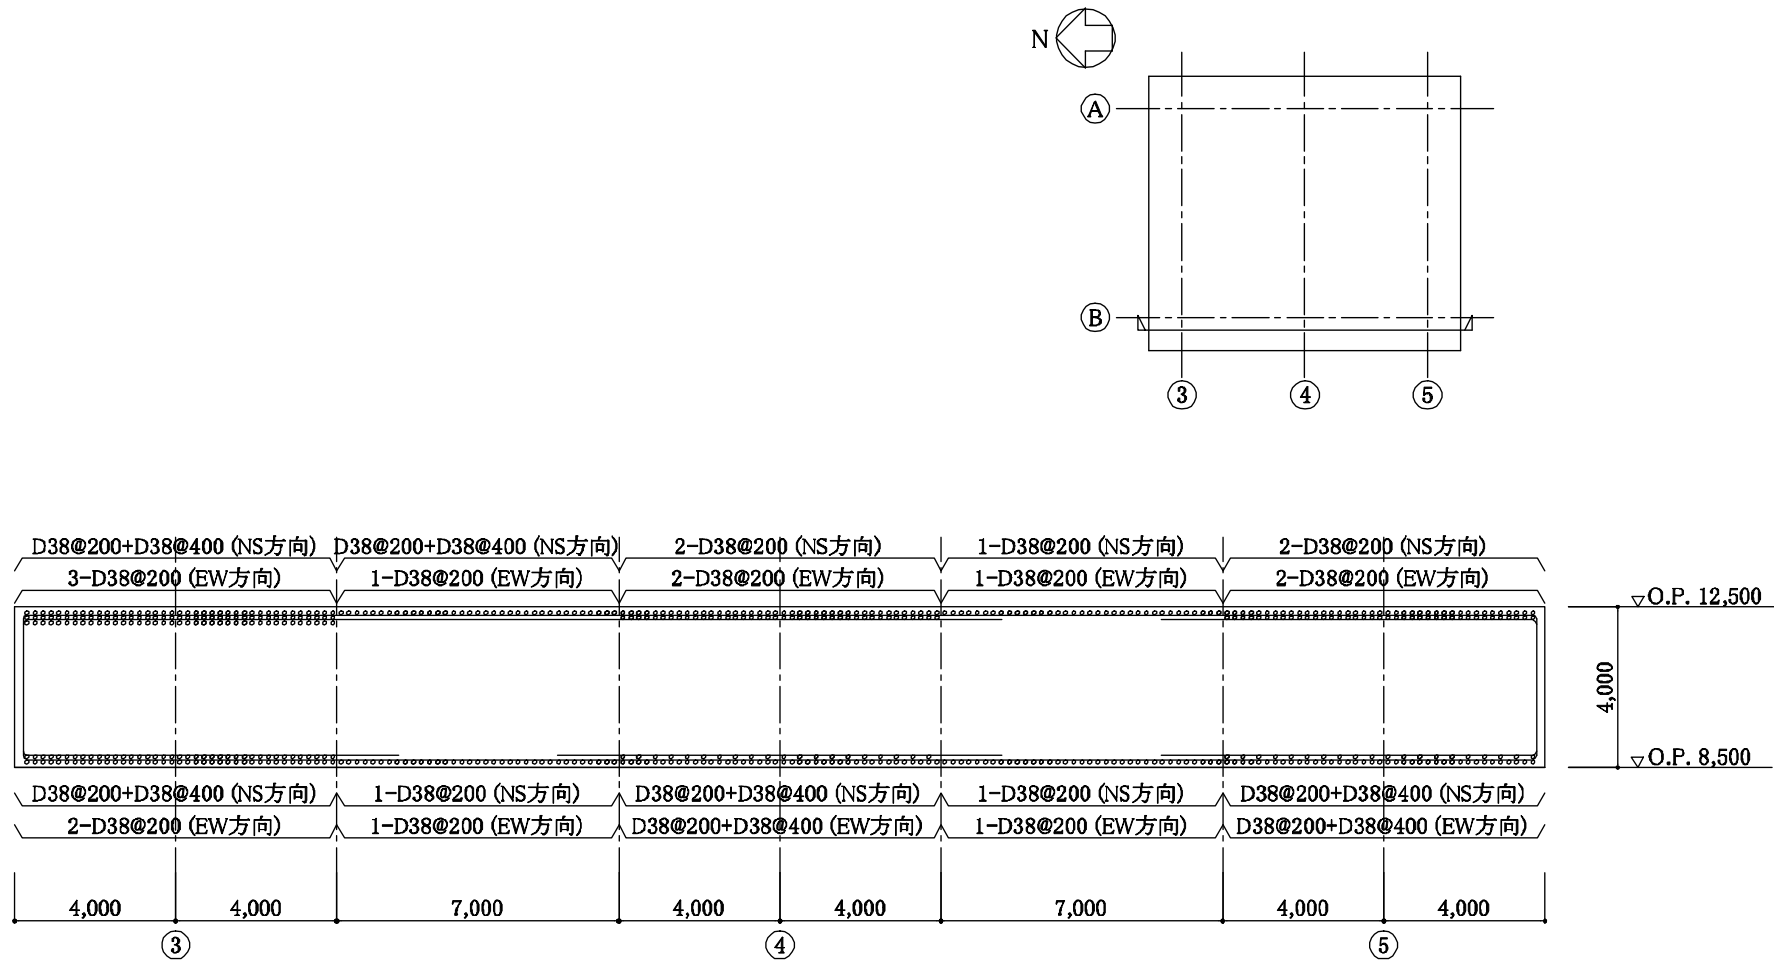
基礎スラブの配筋図 (B 通り) (単位 : mm)
